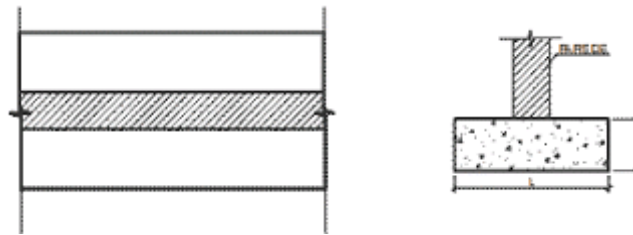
Representação em planta e corte de uma sapata contínua de suporte a uma parede
